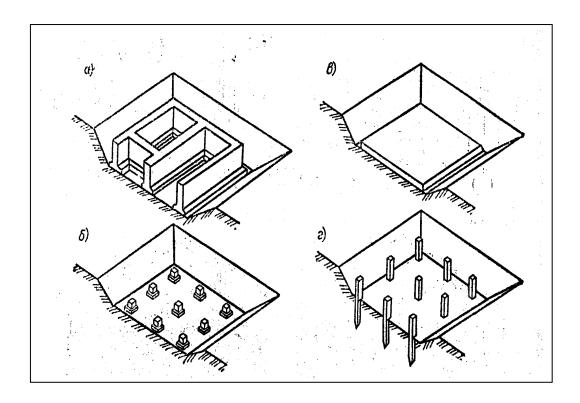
Виды фундаментов а) ленточный, б) столбчатый, в) сплошной, г) свайный
